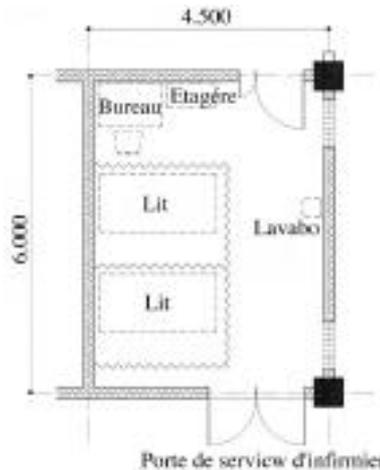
Plan de l'infirmierie (unité : mm)
